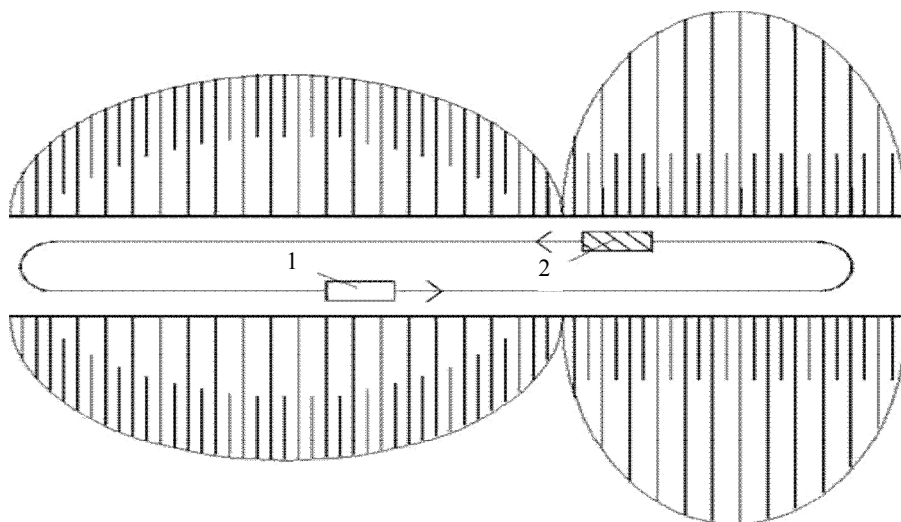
Еліптична схема руху скреперів у суміжний насип: 1 – набирання ґрунту; 2 – розвантаження ґрунту
